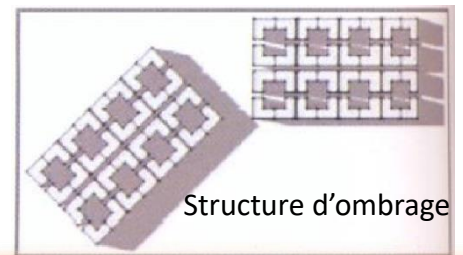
Structure d'ombrage et ventilation dans les constructions de la NV
